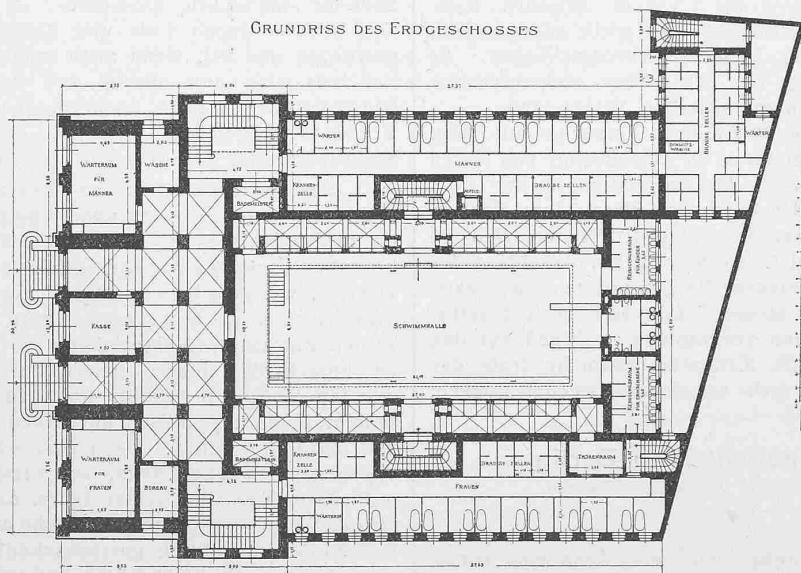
Grundriss vom Erdgeschoss des Volksbades in der Dennewitzstrasse. — 1:500.
